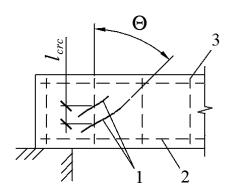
К определению расстояния между наклонными трещинами и угла наклона трещин: 1 – наклонная трещина, 2 – продольная арматура, 3 – поперечная арматура
